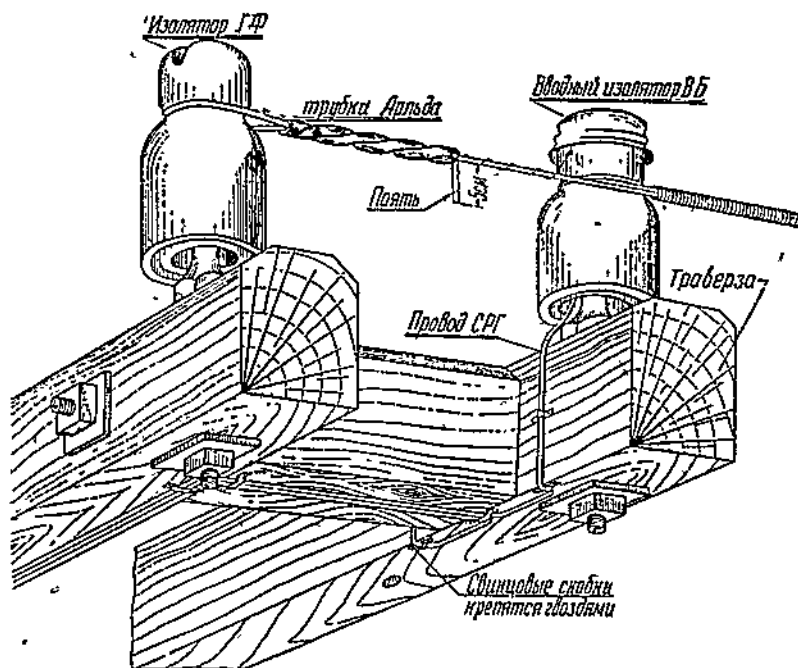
Заделка воздушных проводов на кабельной опоре.
